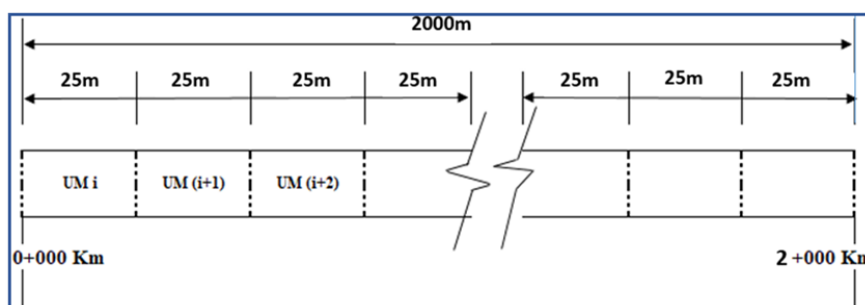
Seccionamiento del pavimento en unidades de muestra.
